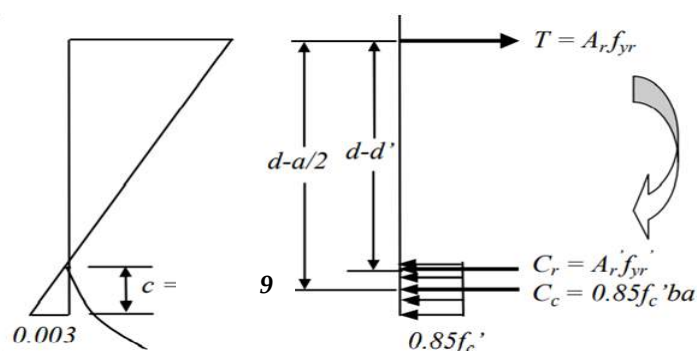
鋼筋混凝土標稱彎矩算式示意圖
